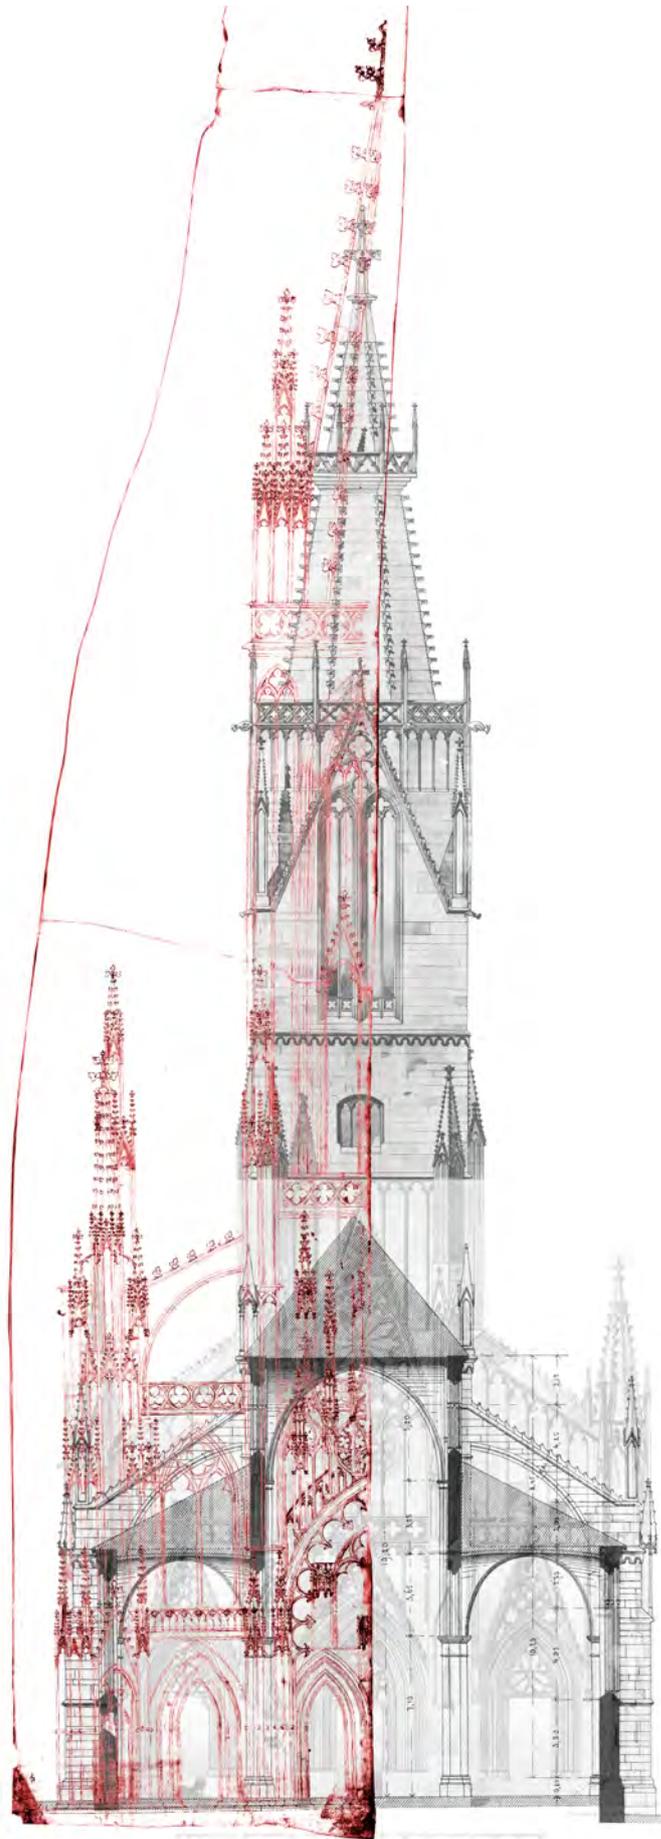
Rissüberlagerung im Maßstab 1:48 mit der Westfassade und dem Querschnitt der Marienkirche in Reutlingen
